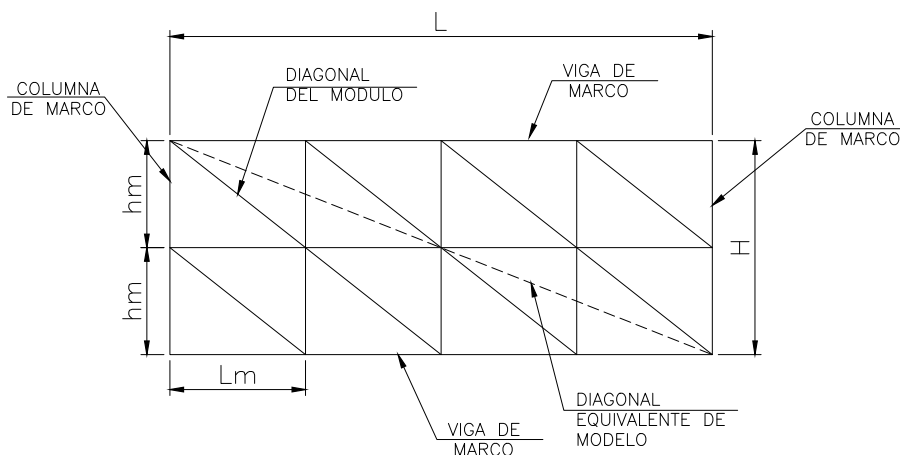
Croquis del modelo del puntal de mampostería adaptado
